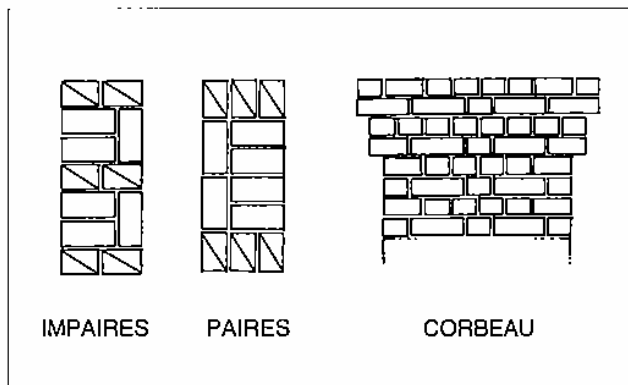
a : Appareillage du pilier et du corbeau (façade cour).
